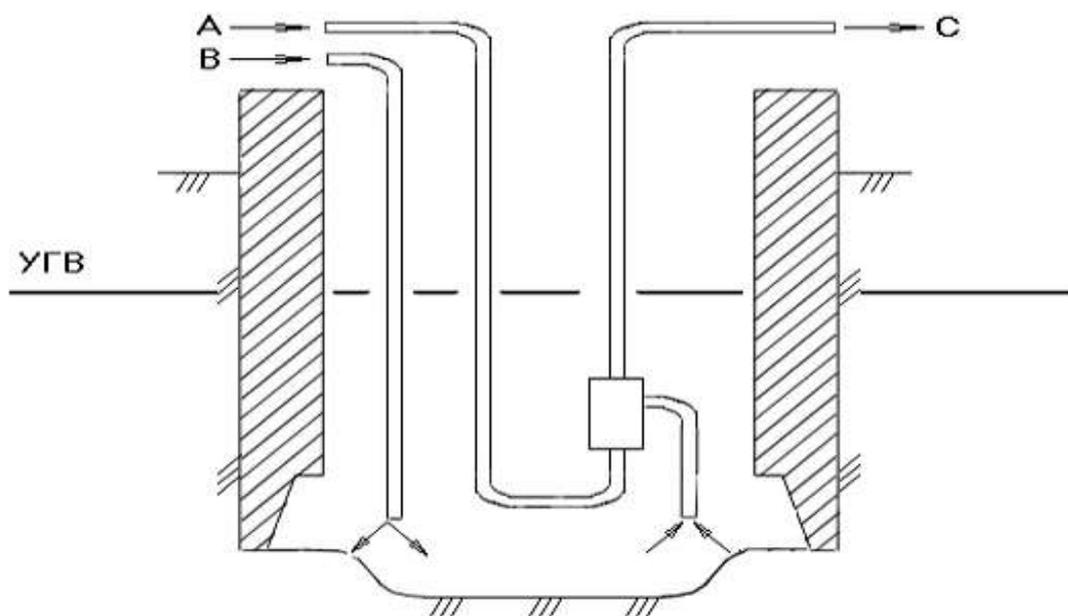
Схема разработки грунта гидромеханическим методом при помощи гидроэлеватора (а – вода; б – вода; с – вода с грунтом.) и эрлифта (а – воздух; б – вода; с – вода с грунтом)
